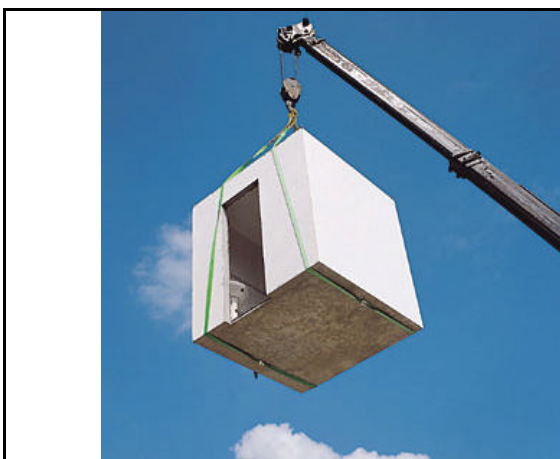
Detalhe de içamento do banheiro pré-fabricado (CORBIOLLI, 2001)
